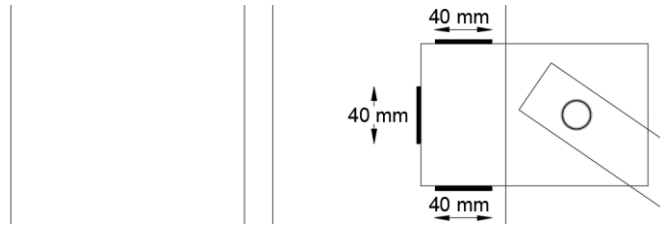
Longitud del cordón de soldadura entre el patín inferior de la viga y la placa. Realizado por: Autor
